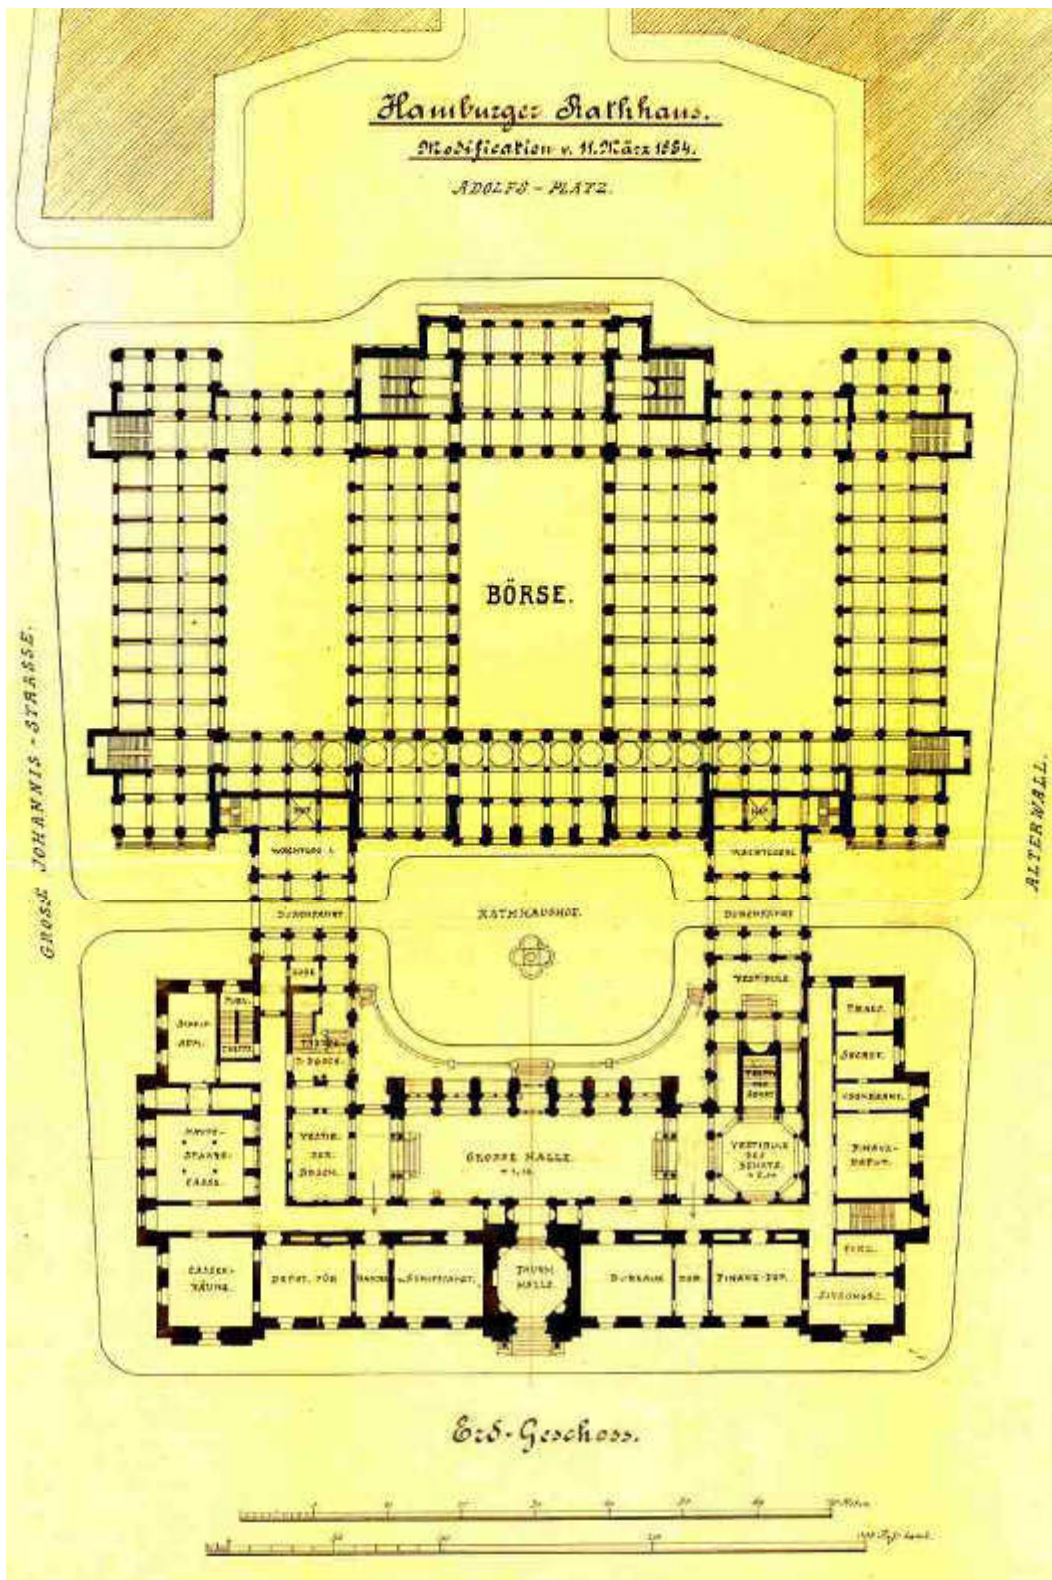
Grundriss Erdgeschoss mit Börse vom 11. März 1884.
